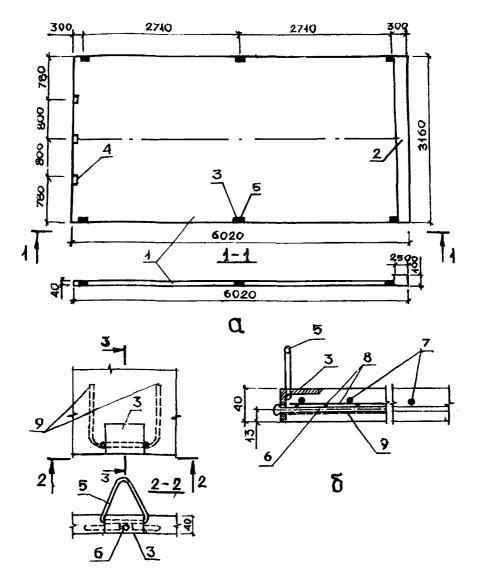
Конструкция предварительно напряженной гибкой пластины с совмещенными соединительными и монтажными закладными деталями; а-опалубочный чертеж пластины; б-деталь установки совмещенной закладной детали; 1-гибкая пластина; 2-уголшение у ендовы; 3-с-закладные детали для соединения пластины с оболочкой КСО; 5-закладная деталь падающая петля) для подъема пластины; спредварительно напрягаемый арматурный элемент с высаженными головками; —предварительно напрягаемый арматурный глаемая арматура продольного направления; 6-сварная сетка для доподнительной анкеровки закладной детали; 9-анкера закладной детали
